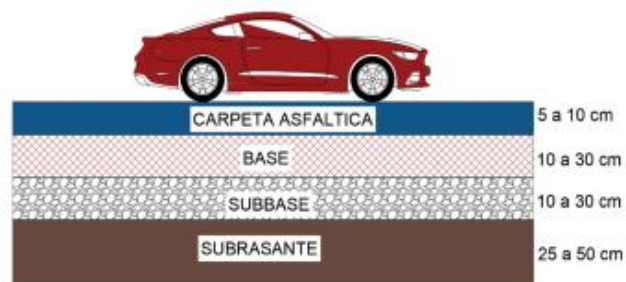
Estructura del Pavimento Flexible.
